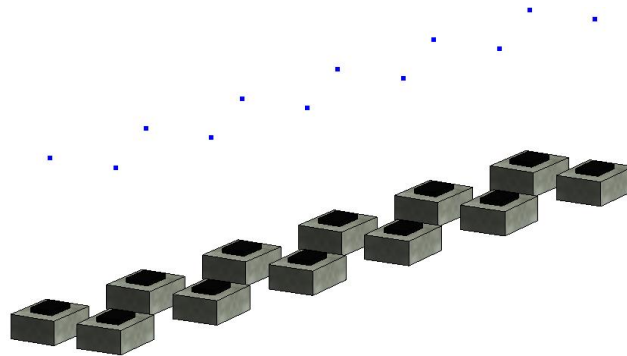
Implantação dos Aparelhos de apoio no Revit.
